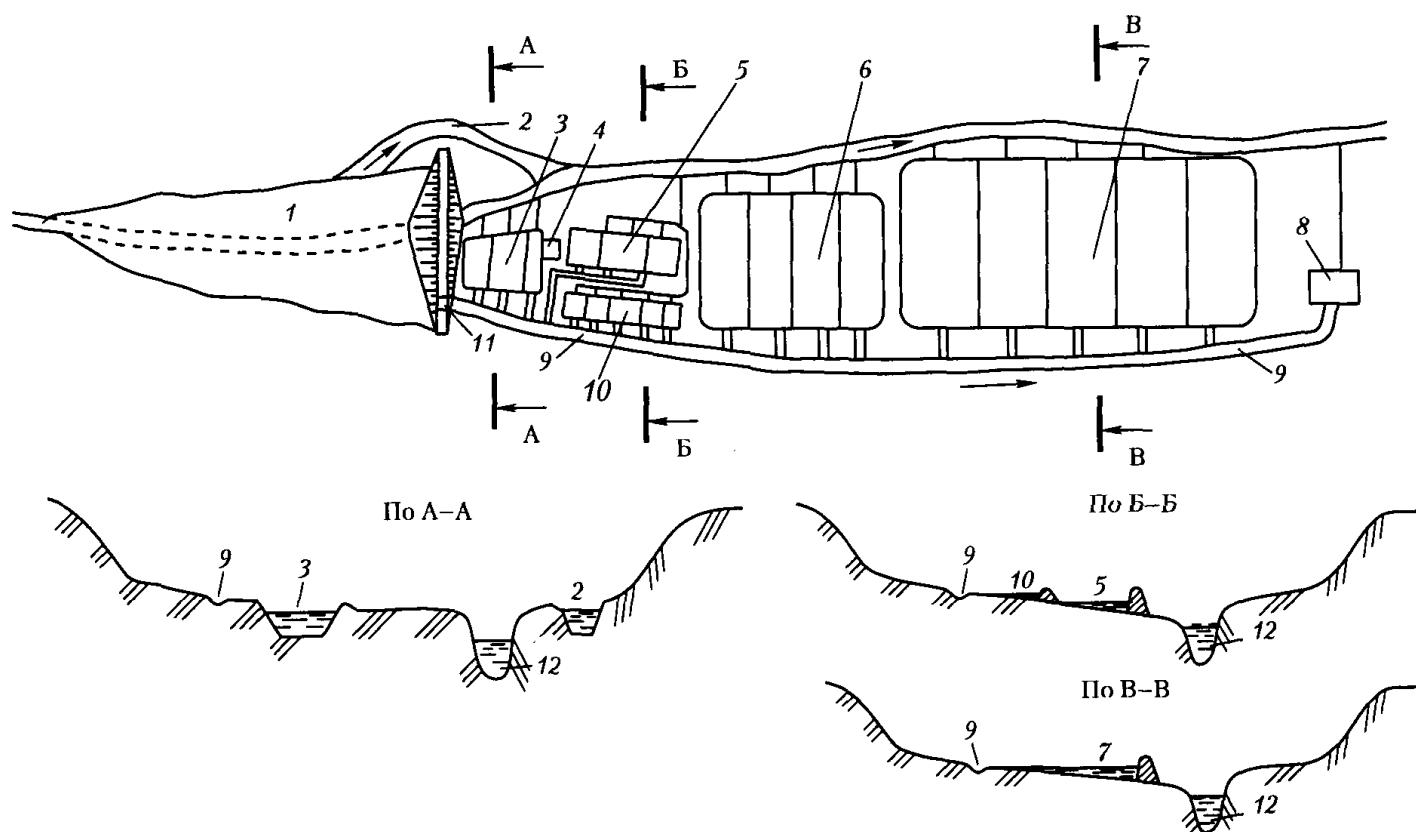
Схема полносистемного рыбхоза с самотечным водоснабжением из головного пруда: 1 – головной пруд; 2 – паводковый водосброс; 3 – зимовальные пруды; 4 – садки; 5 – летние маточные пруды; 6 – выростные пруды; 7 – нагульные пруды; 8 – карантинный пруд; 9 – магистральный канал; 10 – нерестовые пруды; 11 – водозабор магистрального канала; 12 – река
